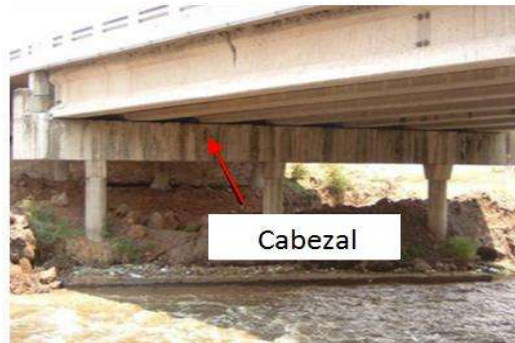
Puente ubicado en la carretera Maravatio-Atlacomulco (López, 2011).
